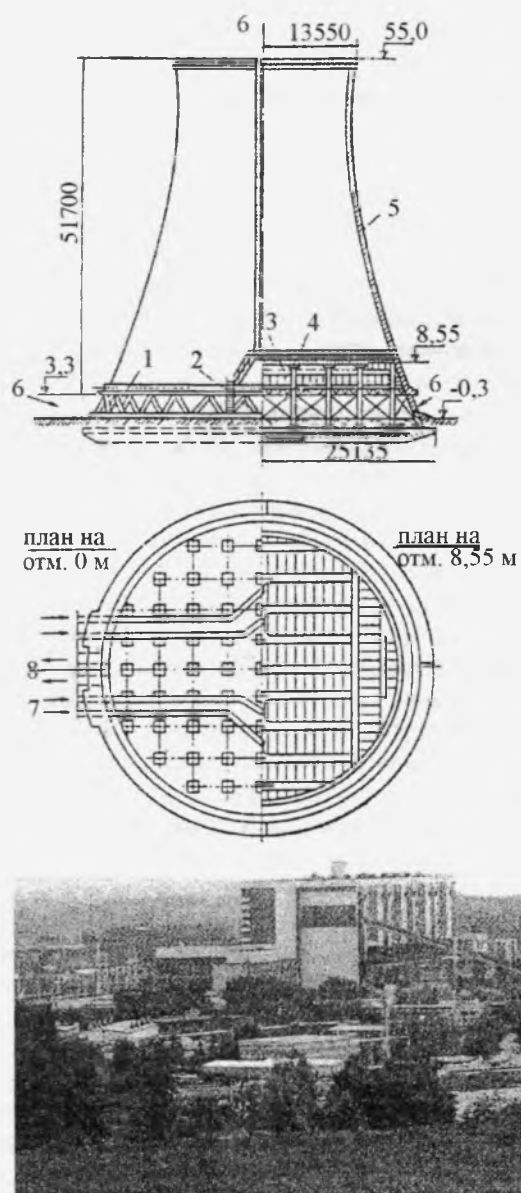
Гиперболическая градирня закрытого типа: 1 — железобетонная колоннада; 2 — резервуар; 3 — пленочный ороситель; 4 — водораспределительное устройство; 5 — вытяжная железобетонная башня; 6 — направление потока воздуха; 7 — подвод теплой воды по стальным трубам; 8 — отвод охлажденной воды по железобетонным каналам
